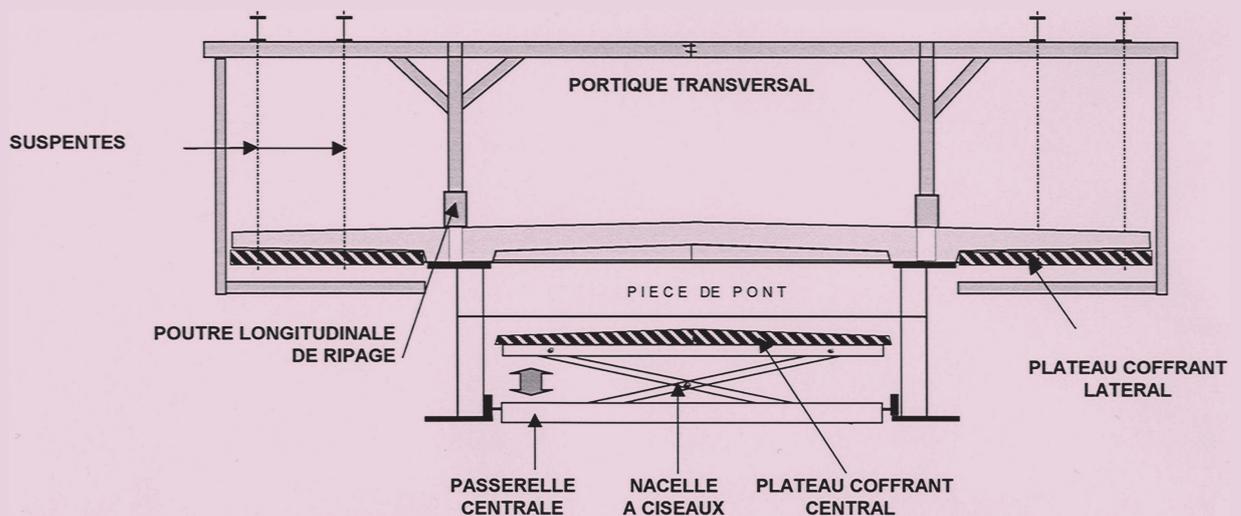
Équipage mobile pour bipoutre à pièces de pont sans console
